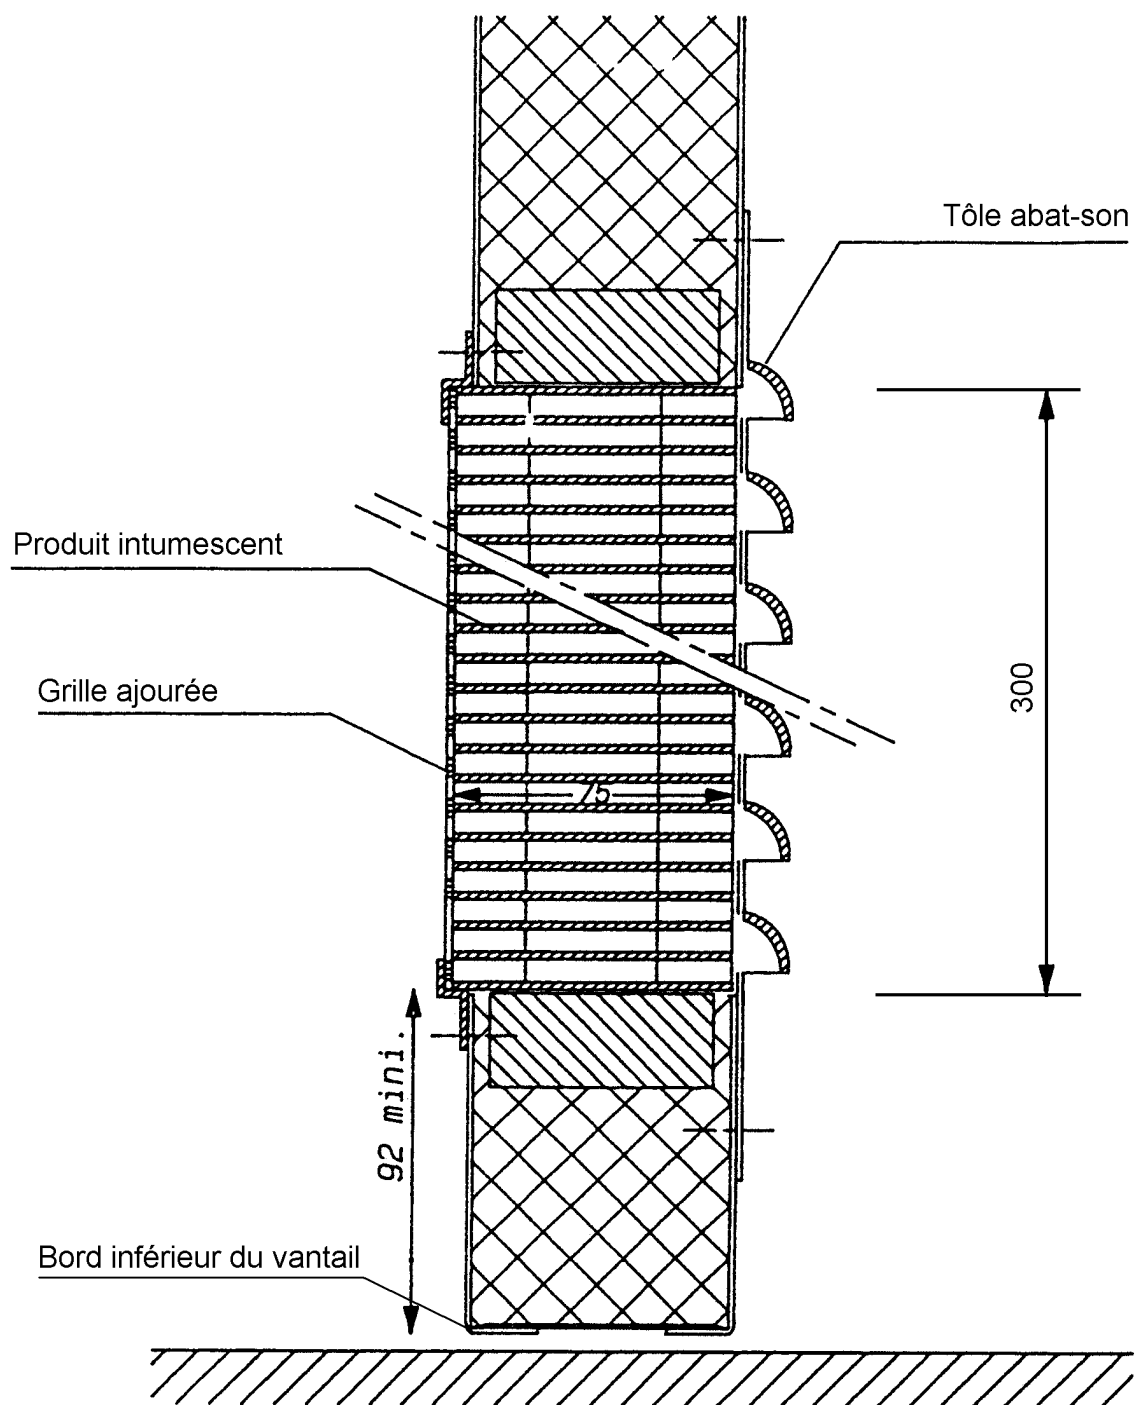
Coupe verticale de la grille de ventilation en bas du vantail
